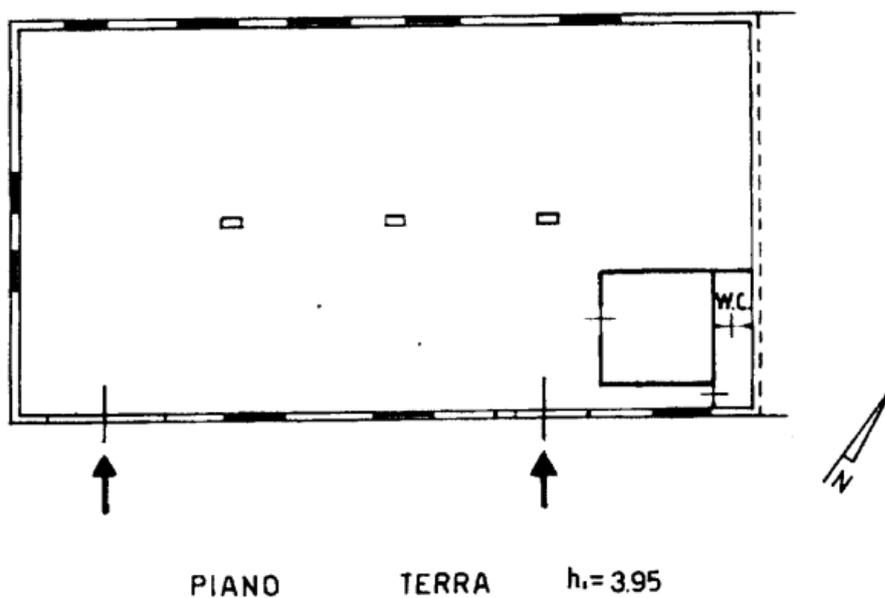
Planimetria catastale sub 10 (u.i.u. divisa in due depositi di cui al corpo di fabbrica lato sx)
